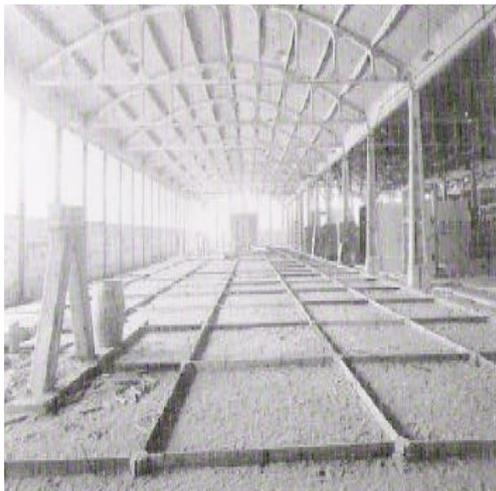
Galpão industrial com vigas Vierendeel de concreto armado.
